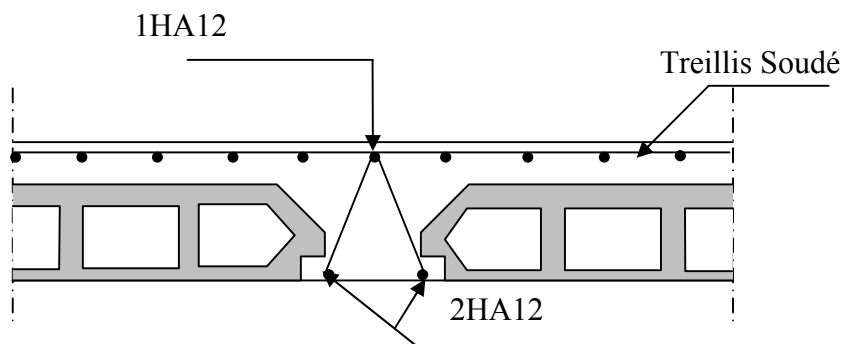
Schéma de ferrailage d'un plancher courant.
